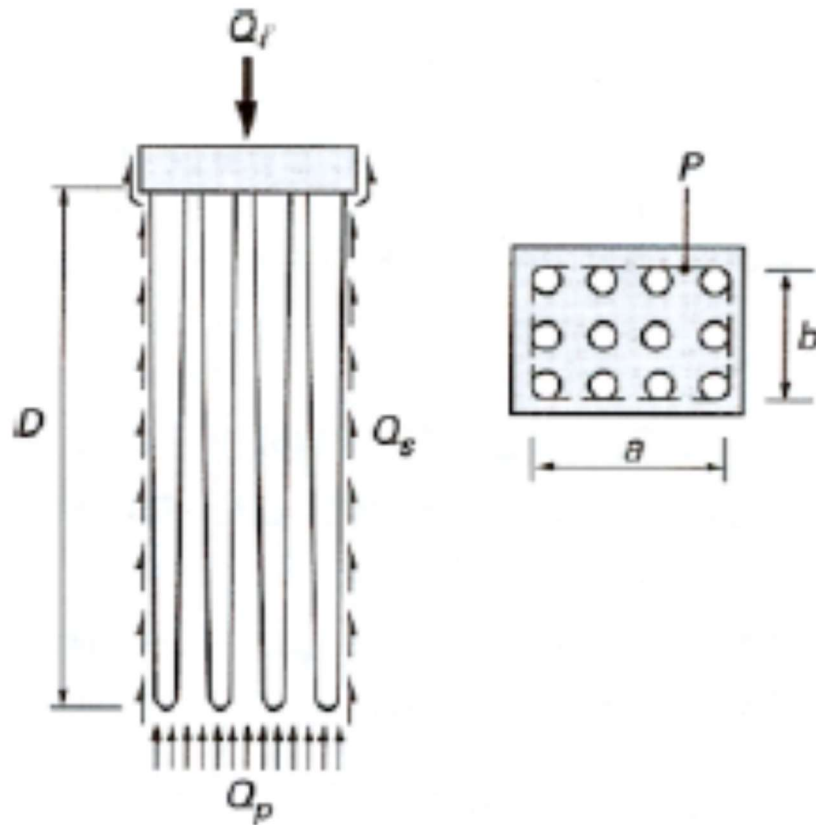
Fondation équivalente fictive d'un groupe de pieux
